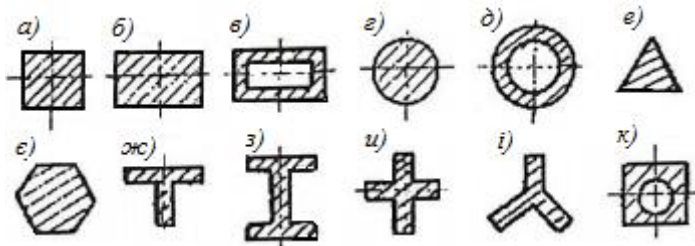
Форми поперечного перерізу паль: а – квадратна; б – прямокутна; в – коробчата; г – кругла; д – кільцева; е – трикутна; є – багатокутна; ж – таврова; з – двотаврова; и – хрестоподібна; і – трилопатева; к – квадратна з круглою порожниною
